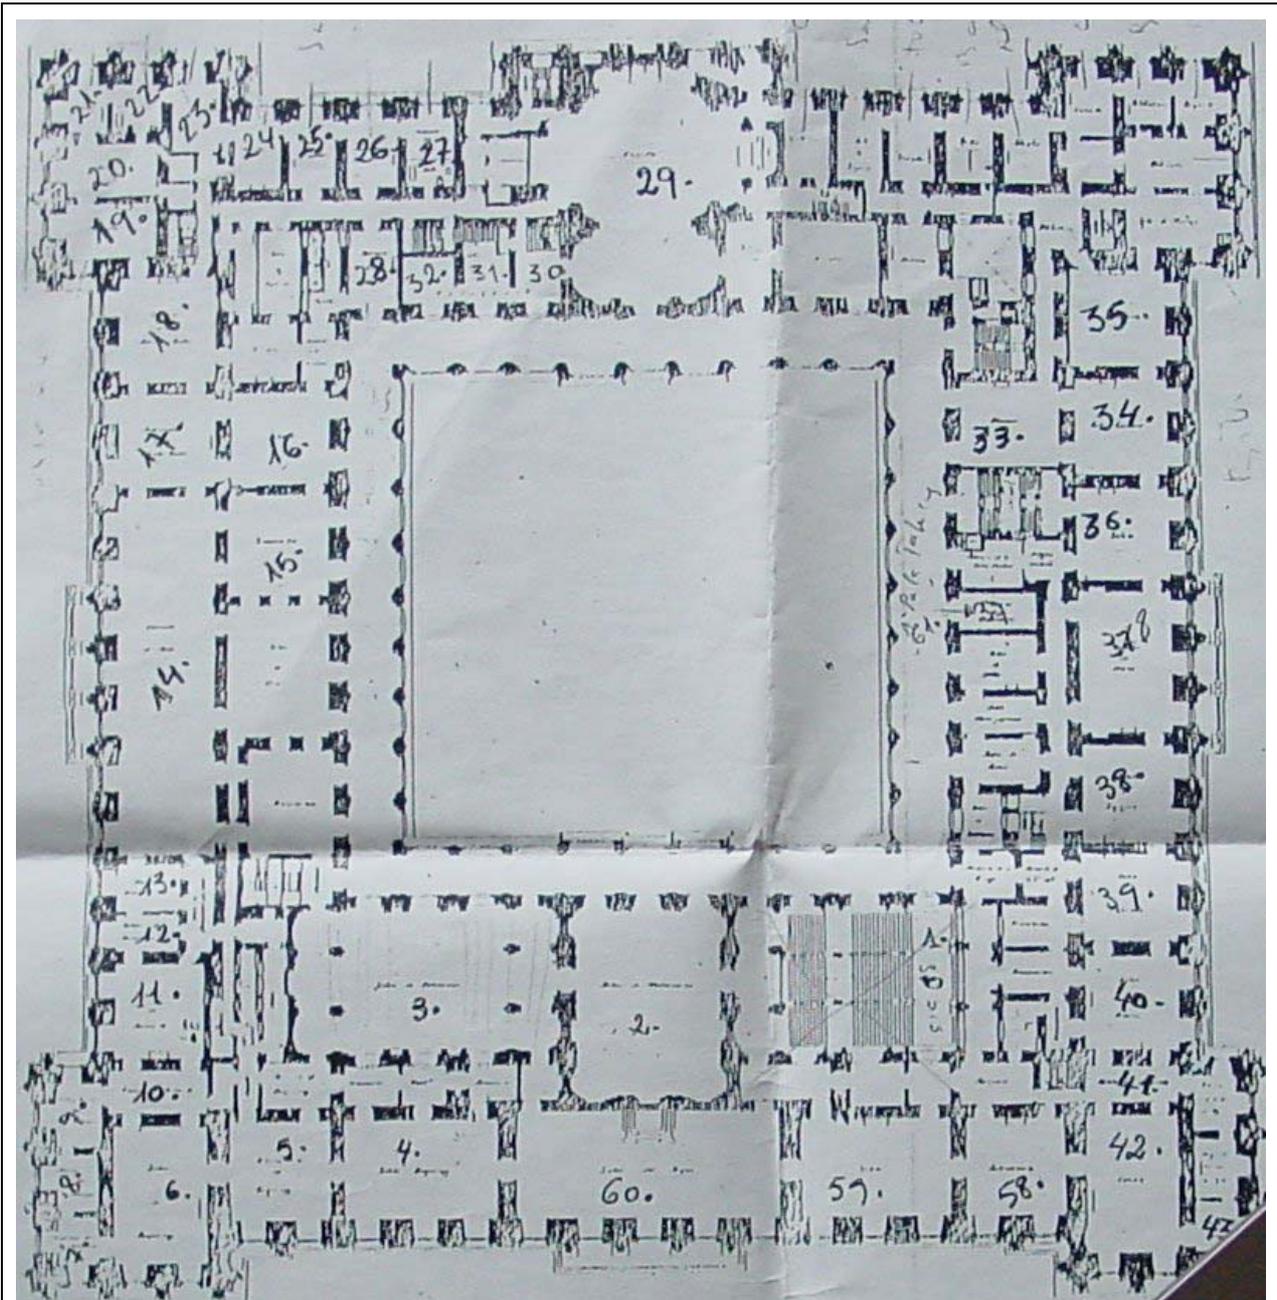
Grundriss des *Palacio Real* zu Madrid
